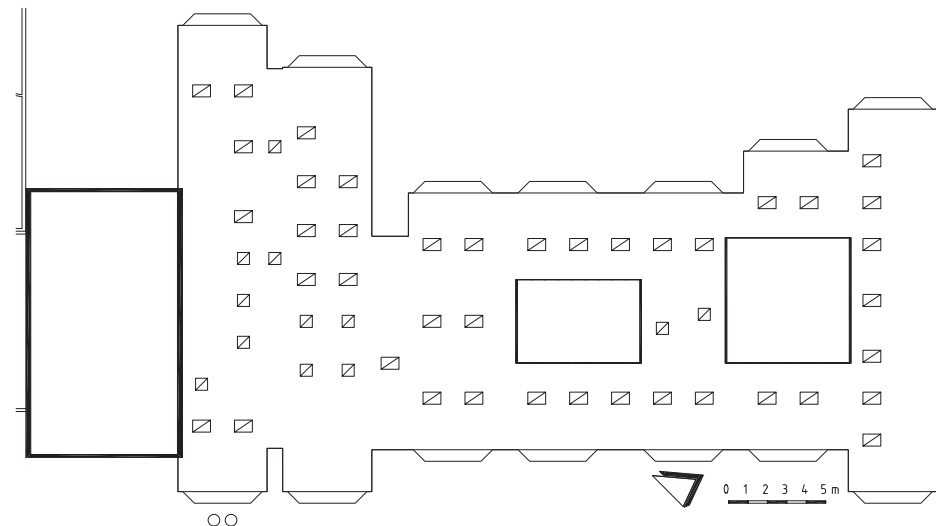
Grundriss Dachdraufsicht Hauptschule Mitterdorf i. M.
